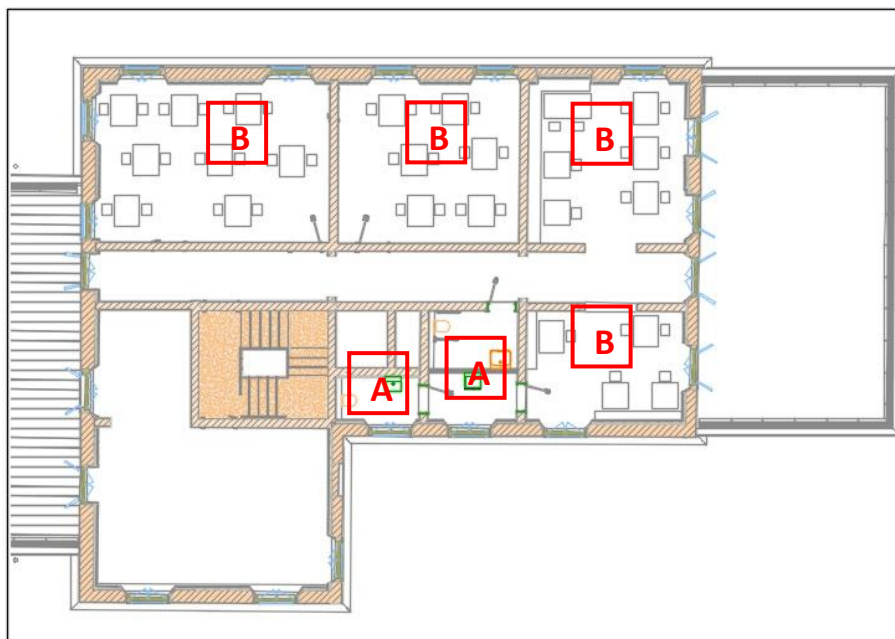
Immagine della planimetria del piano terra del fabbricato oggetto di adeguamento.
